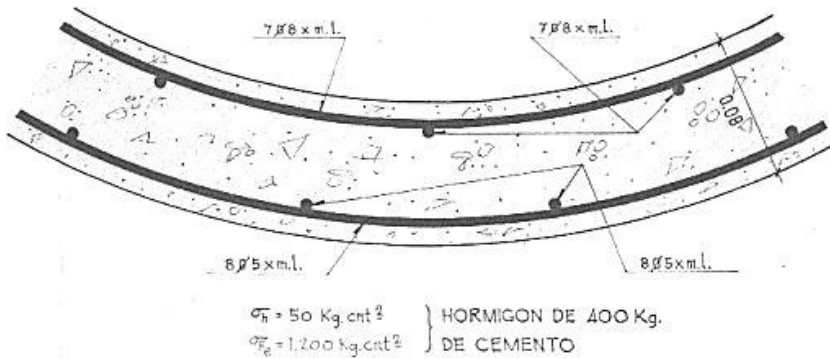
Planos de estructura: Apoyos articulados y estructuras fungiformes.
